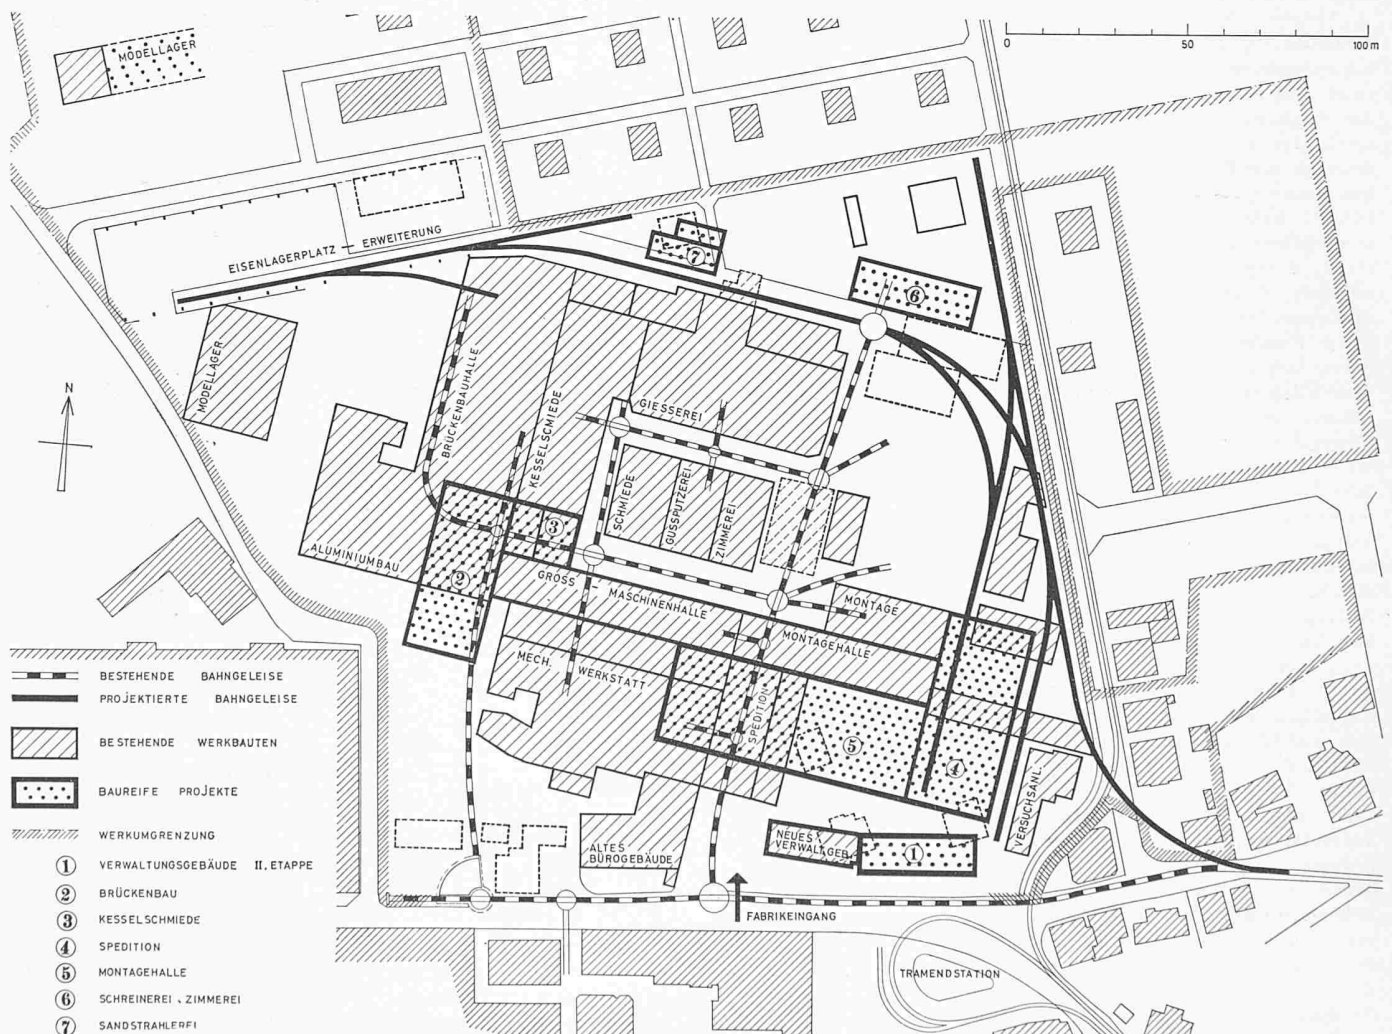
Grundriss der Fabrikanlage 1:2000 mit den projektierten Neubauten
